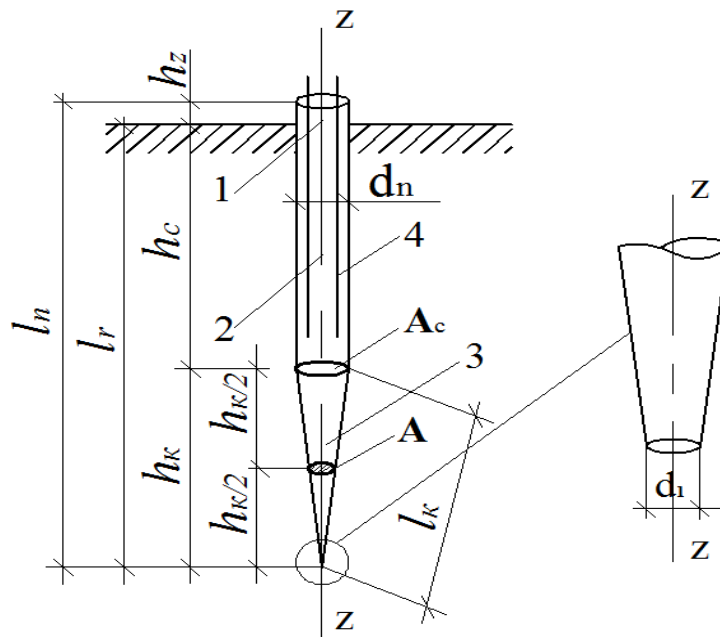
Конструктивная схема НРСо: 1- оголовок сваи; 2- тело сваи; 3- острие сваи; 4- армирование сваи.
